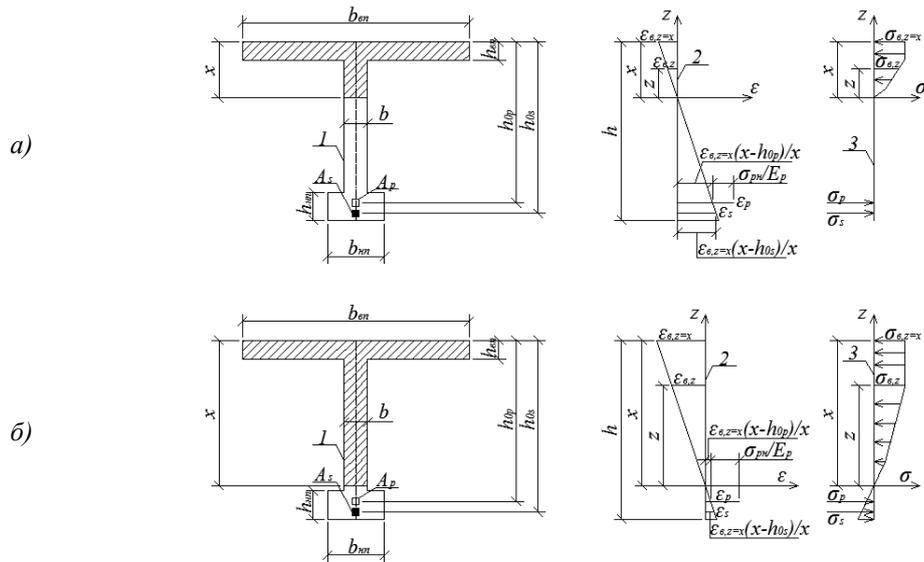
Схемы к деформационному расчёту по прочности (а) и образованию трещин (б) изгибаемых железобетонных балок со смешанным армированием:
